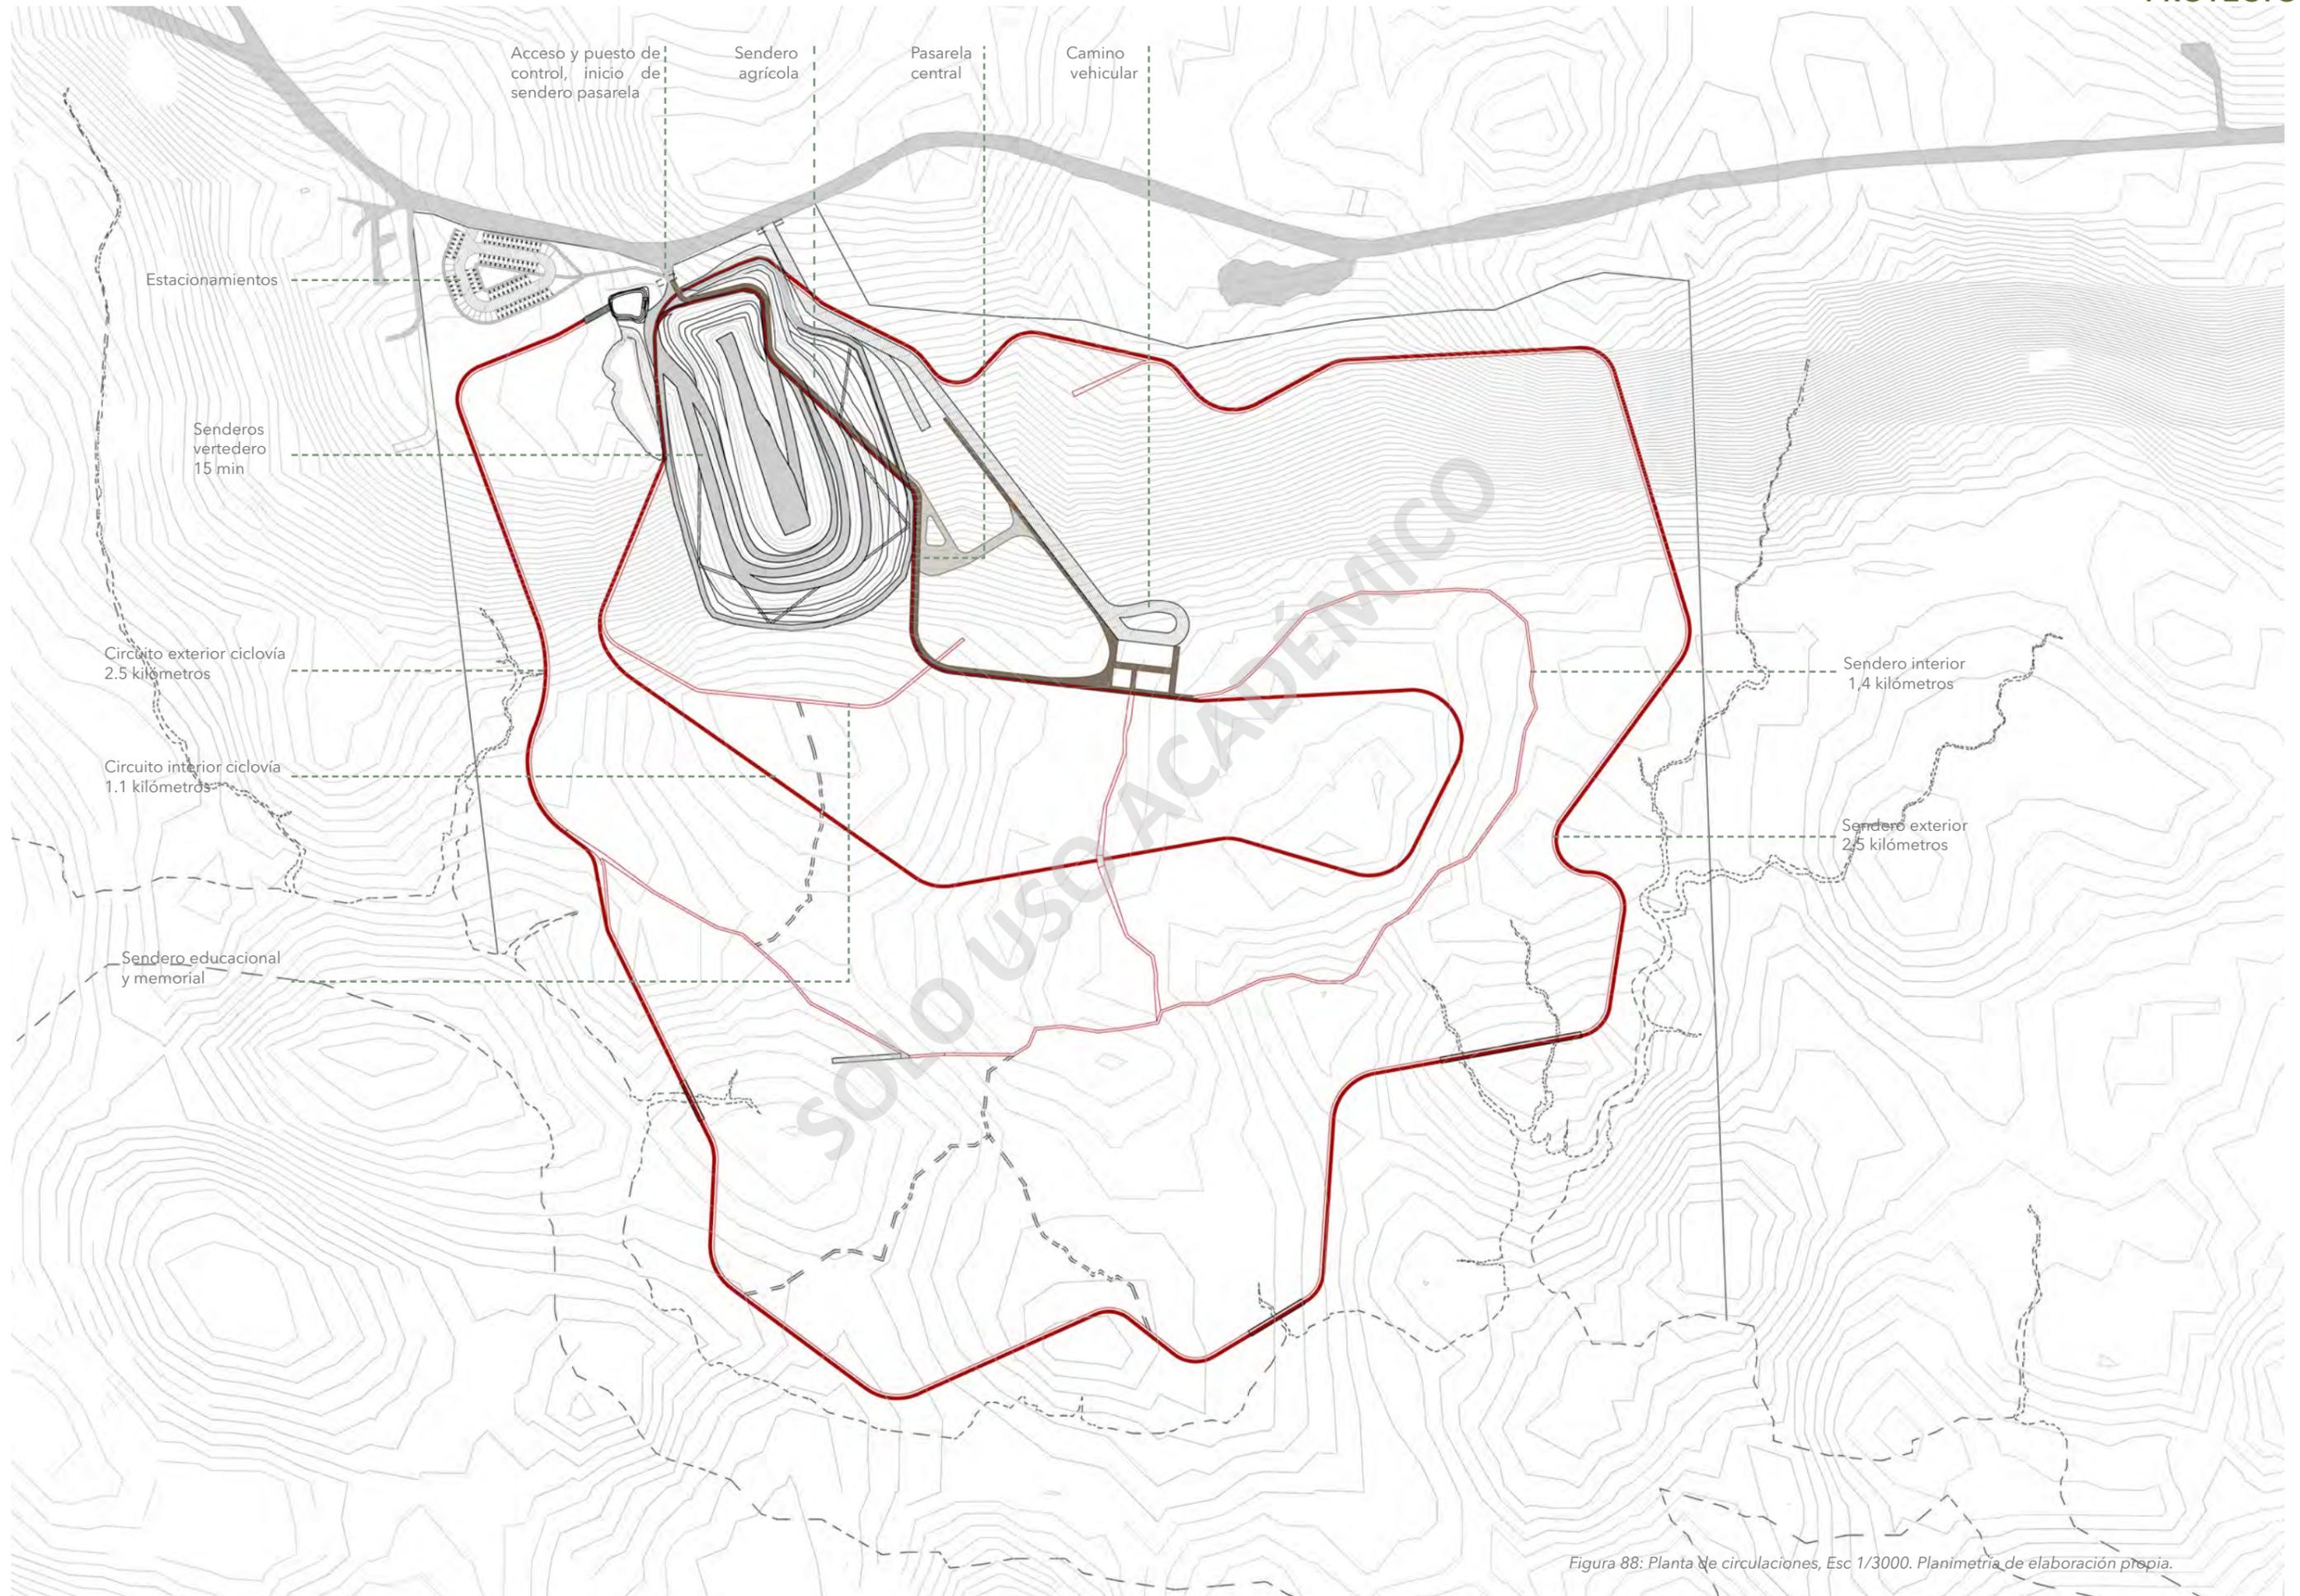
Planta de circulaciones, Esc 1/3000. Planimetría de elaboración propia.
